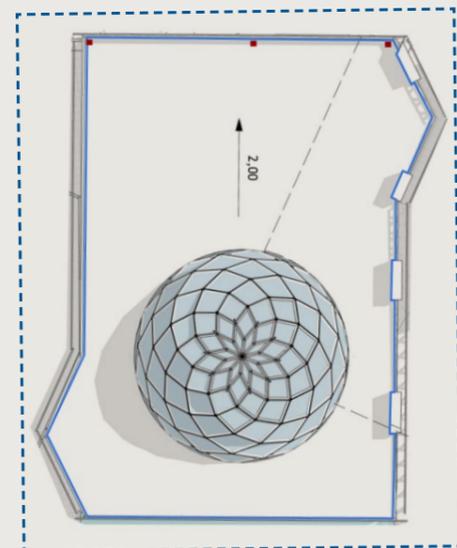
LAJE DA MESQUITA - SUAS QUEDAS D'ÁGUA ACONTECEM NA FACHADA NORTE.
